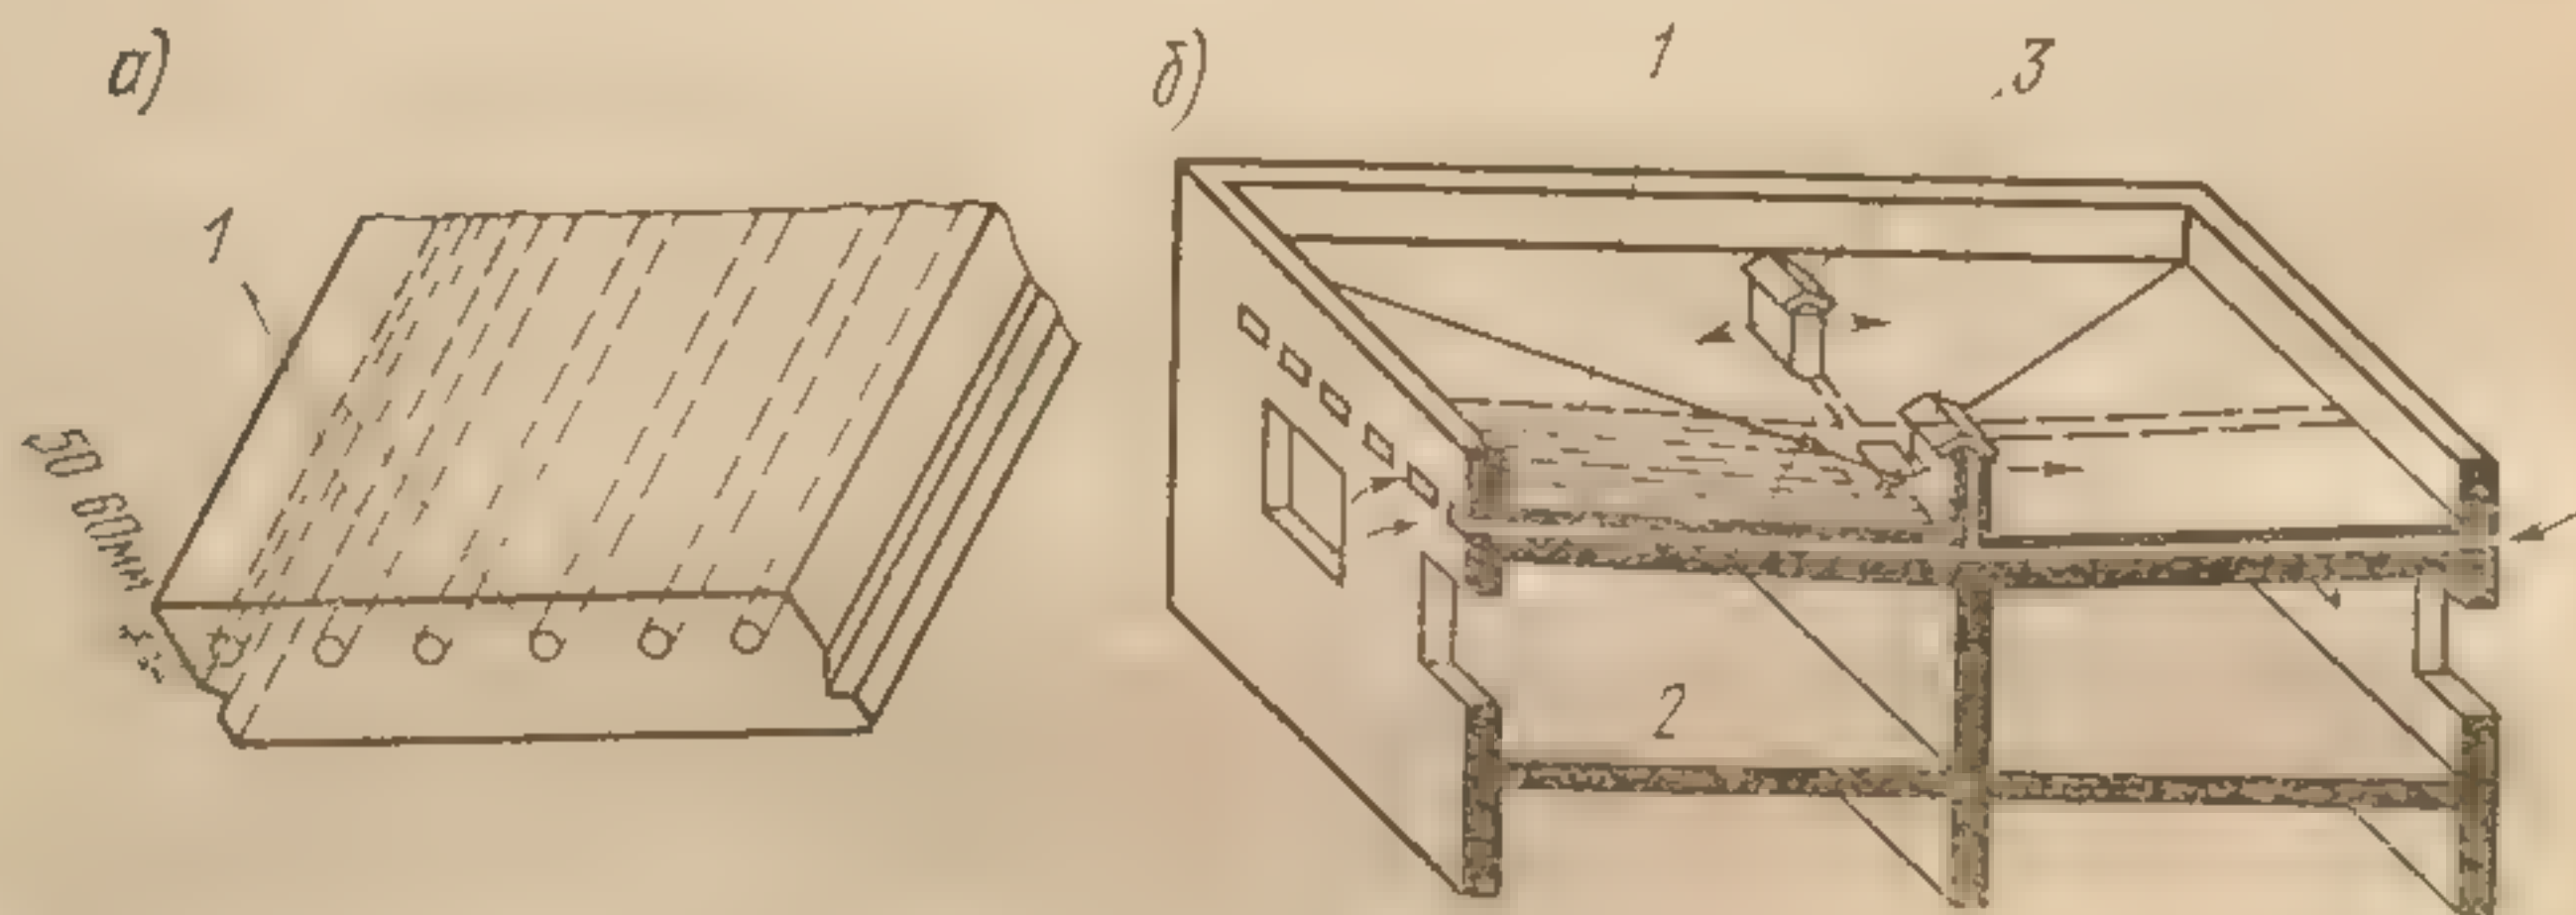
Совмещенная крыша из армопенобетонных панелей с вентиляционными каналами:
